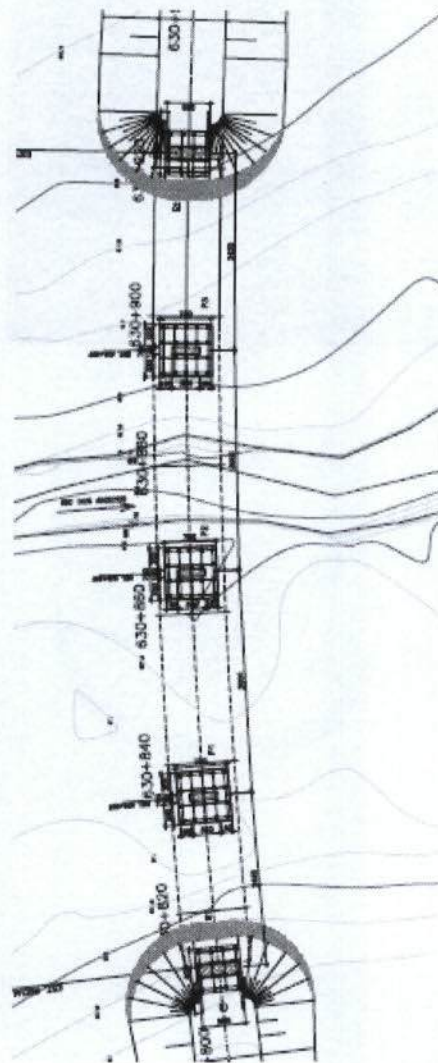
Projeto da ponte sobre o Rio dos Angicos (planta de situação)
